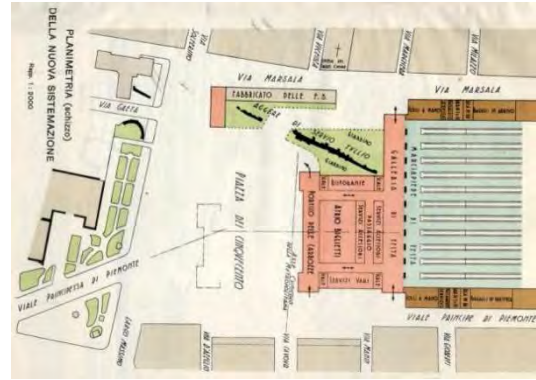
Planimetria (schizzo) della nuova sistemazione – luglio 1946 – Roma
